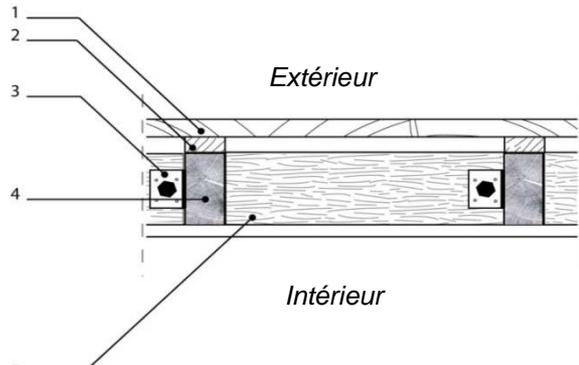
Coupe horizontale de principe : Détail d'ancrage d'une lisse basse d'un mur extérieur sur fondation - panneau courant secondaire de mur de façade
